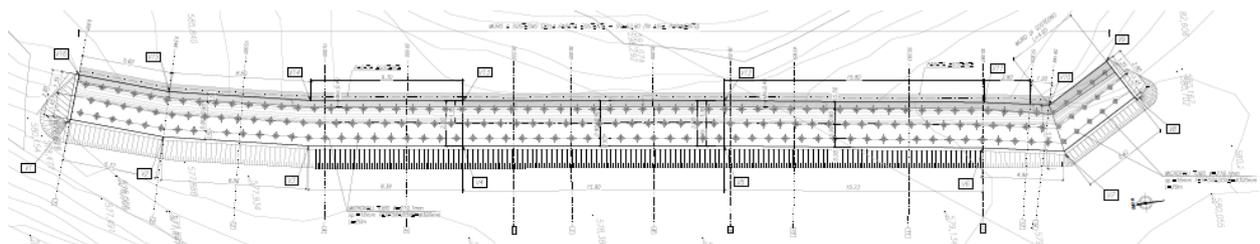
Stralcio planimetrico muro di consolidamento della berlinese esistente.
